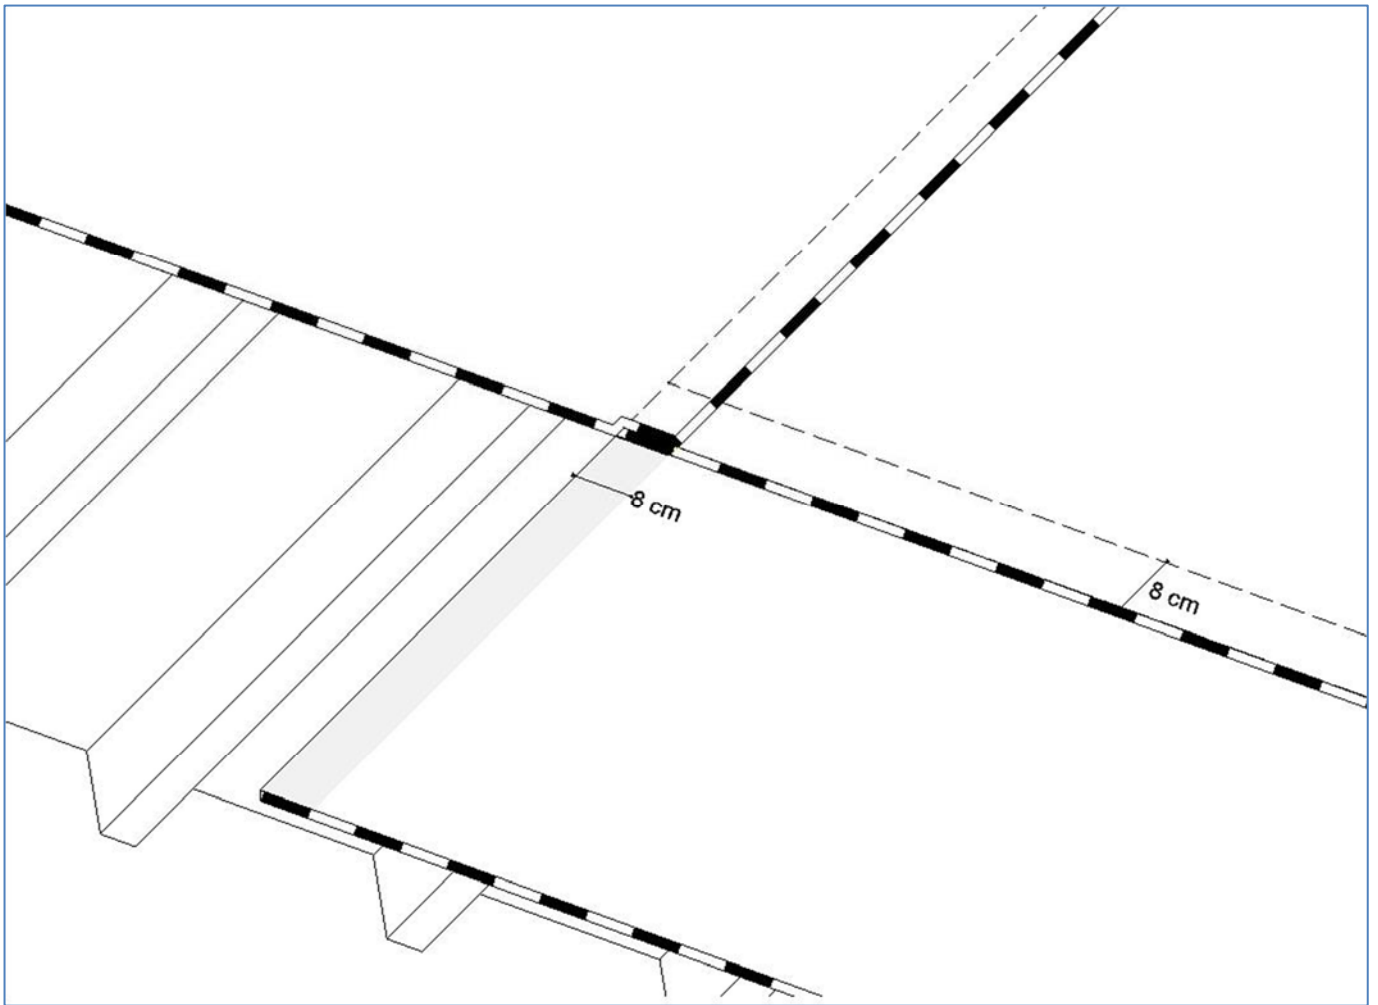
principe des recouvrements des pare-vapeurs BauderTEC DBR et BauderTEC KSD
